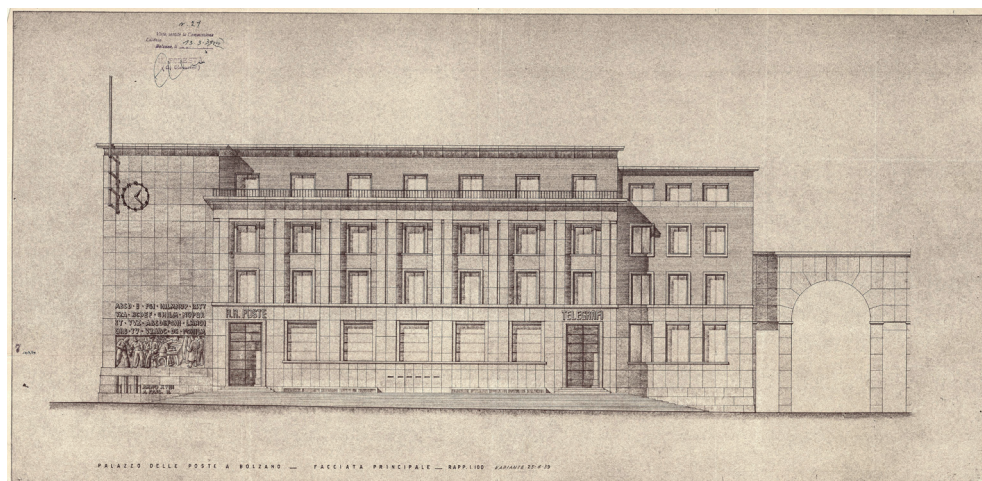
Prospetto del progetto rivisto dell'architetto Rossi De Paoli per l'Ufficio delle Poste in piazza Impero, marzo-aprile 1939. Archivio Storico della Città di Bolzano
